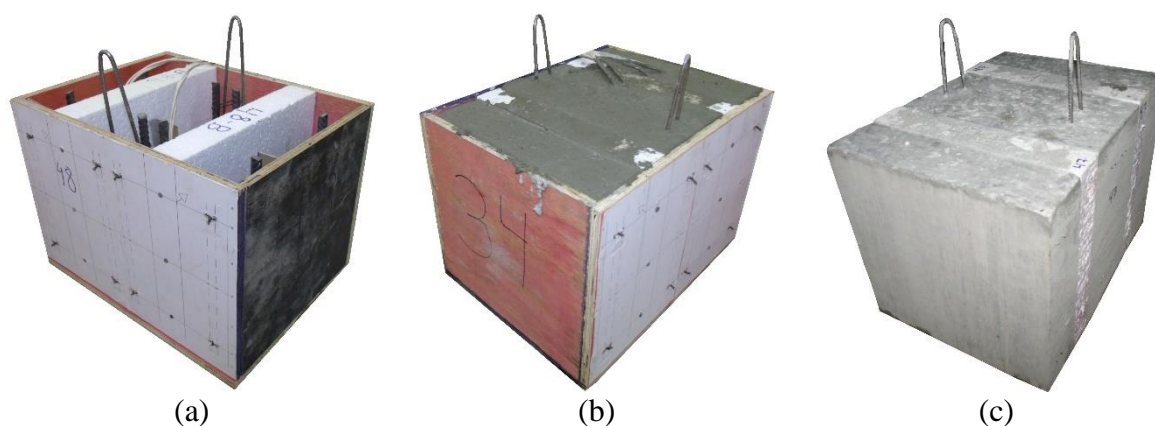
Montagem dos espécimes: (a) posicionamento dos elementos constitutivos; (b) concretagem; (c) bloco após a concretagem.
